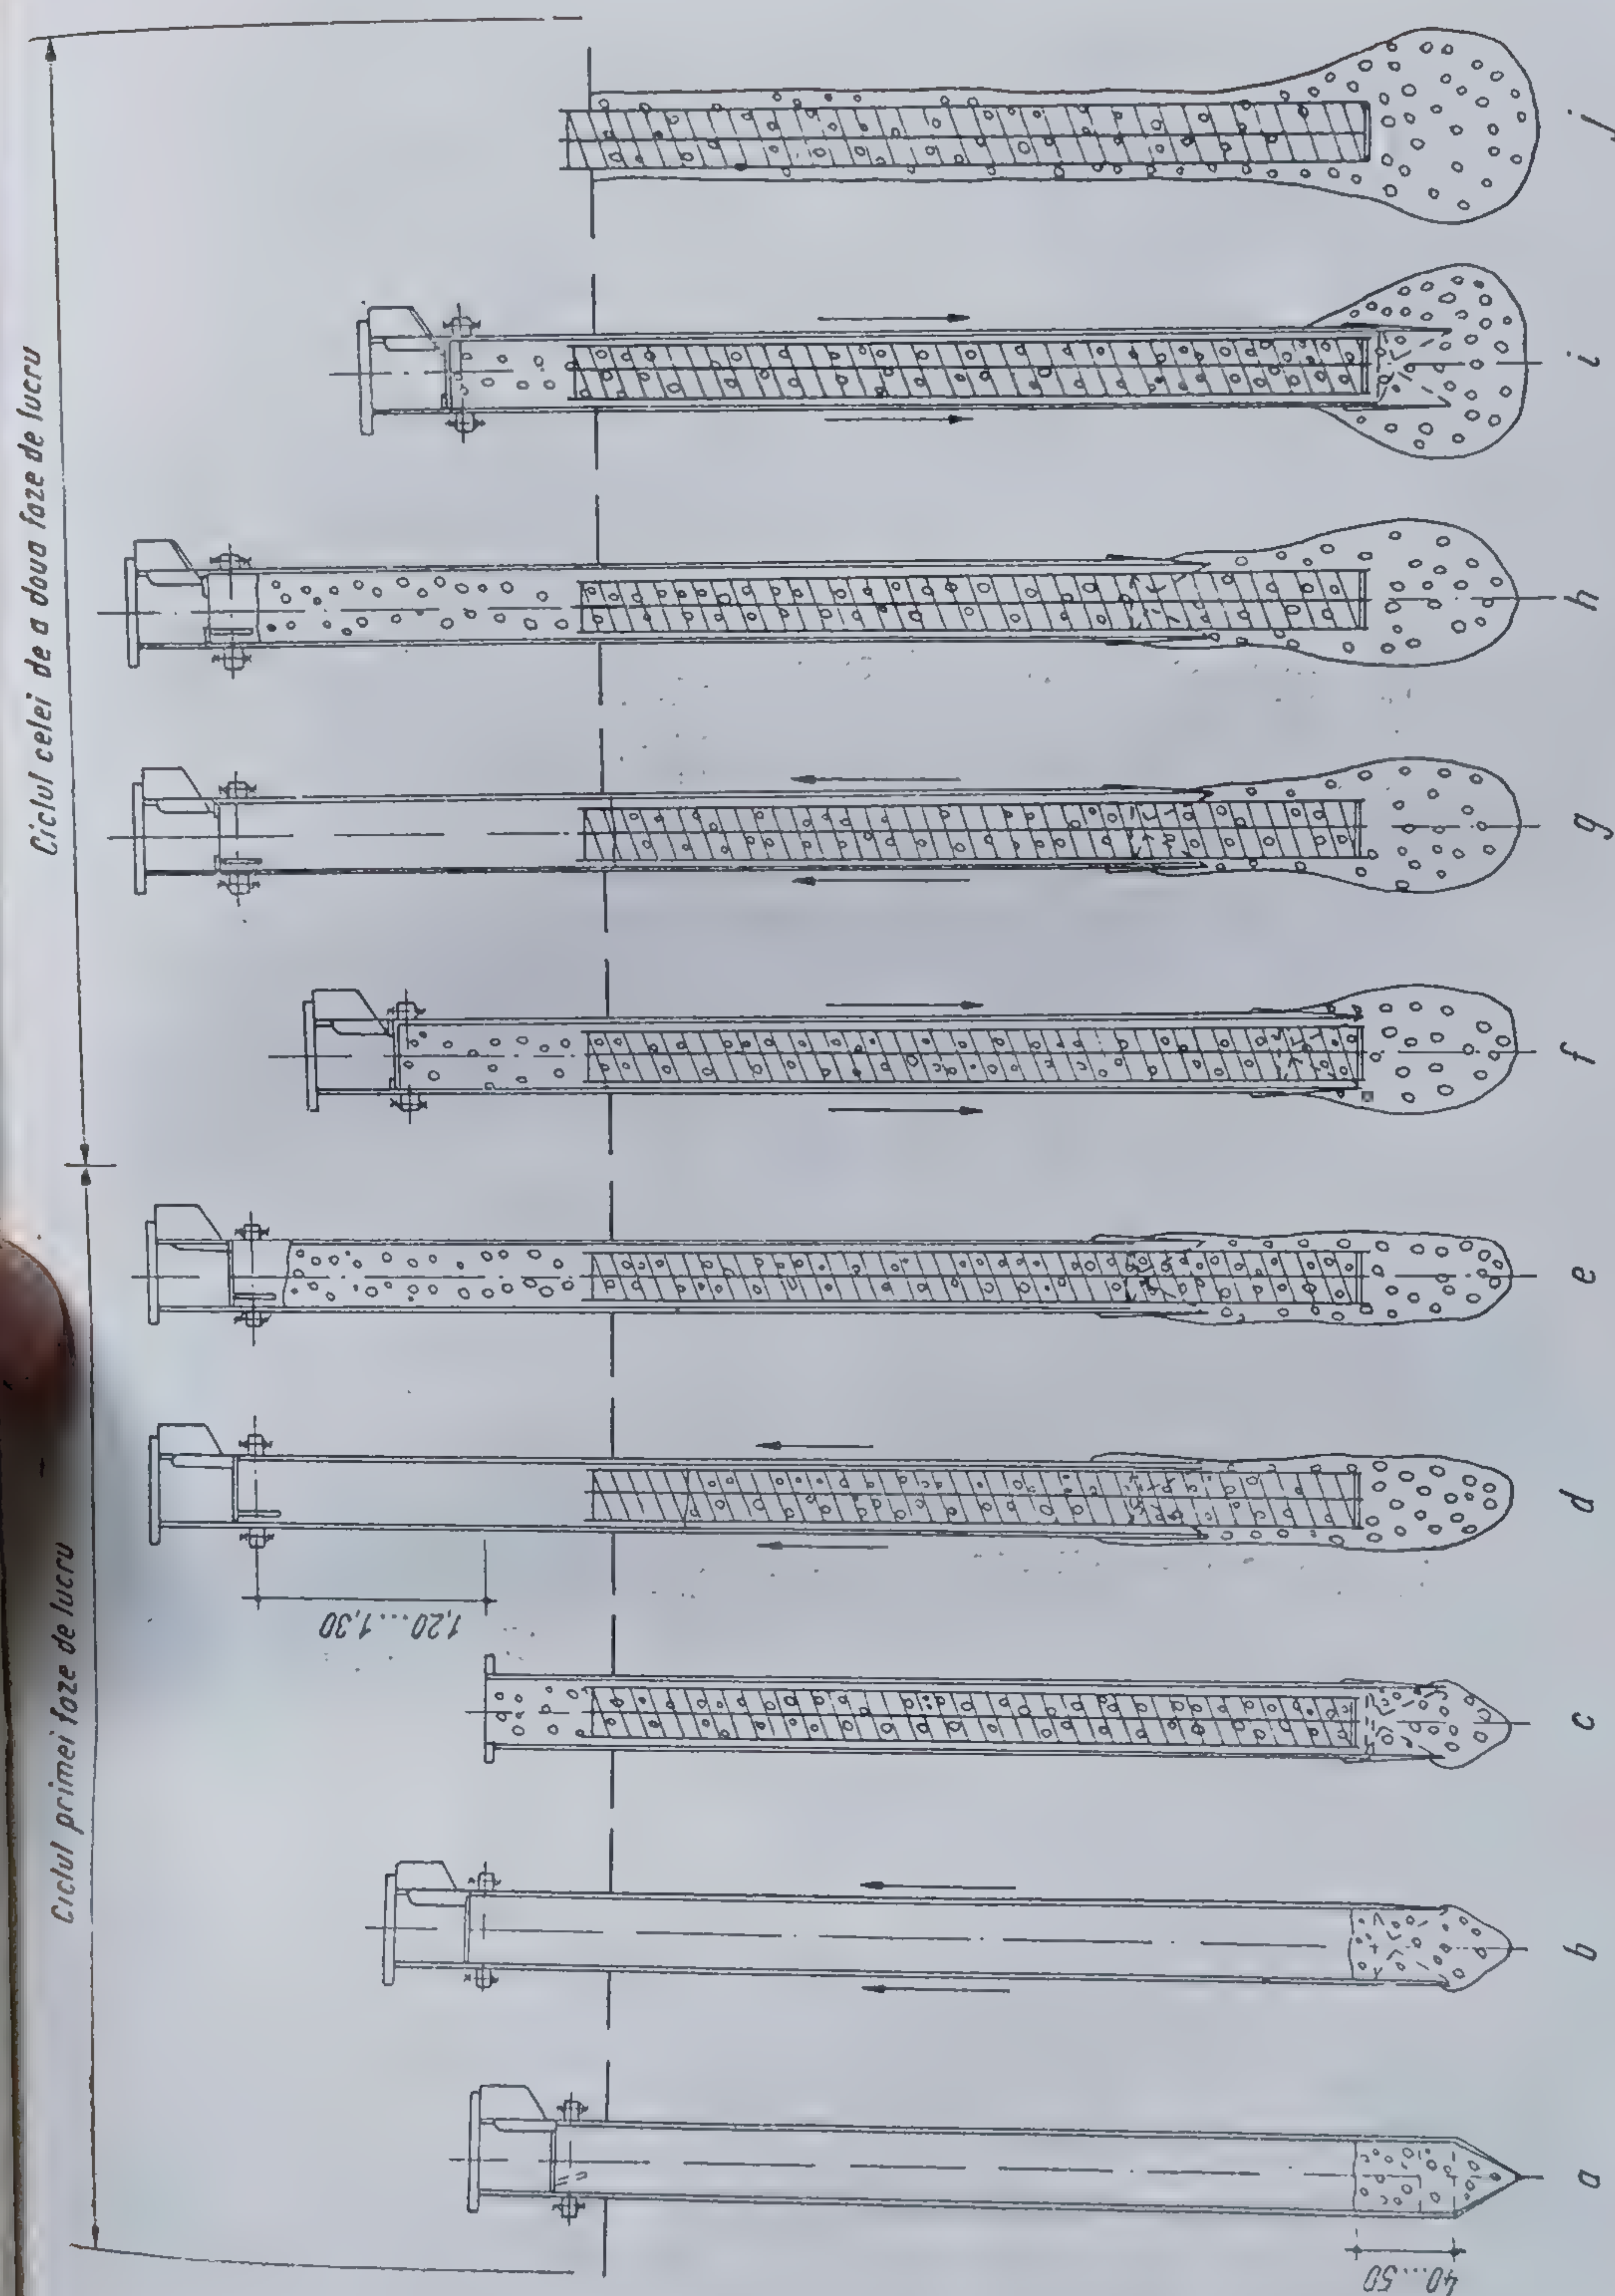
Fazele de execuție a piloților executați pe loc armați pe întreaga lungime.
